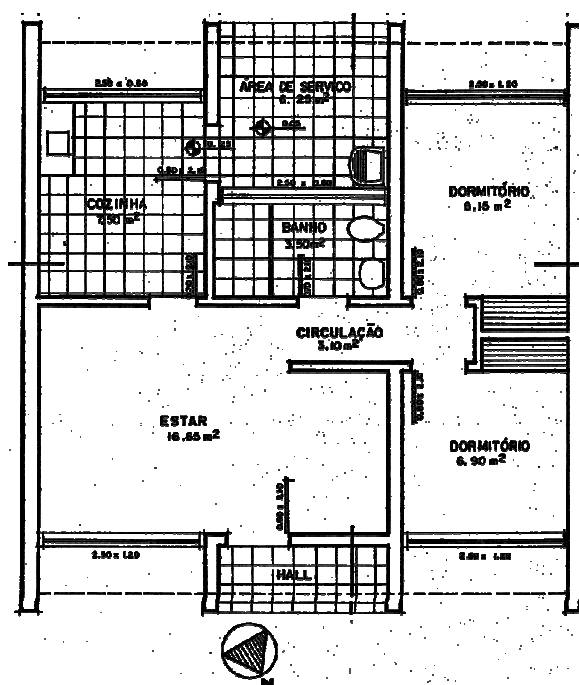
Planta baixa do protótipo habitacional (Fonte: Becker, 1992, p.17).
